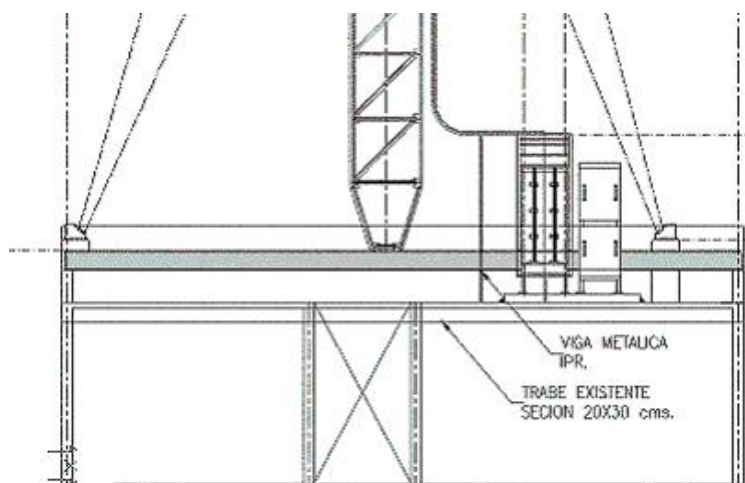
TORRE SOBRE VIGA METÁLICA
